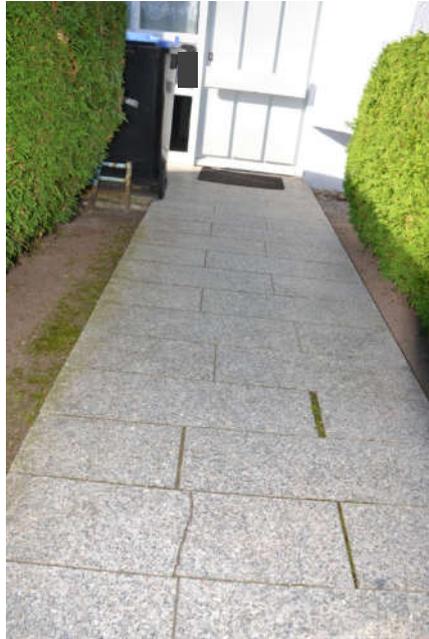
Wegebefestigung zum Hauseingang Pamiersring 118
